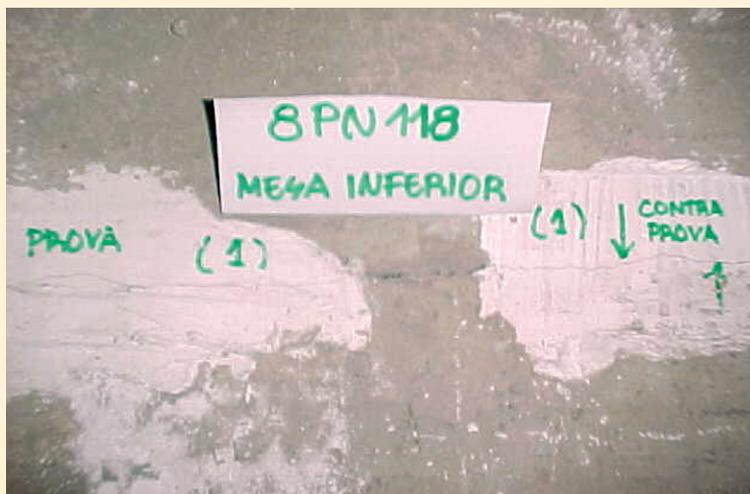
SELOS DE GESSO APLICADOS NA MESA INFERIOR DE ADUELA, EXIBINDO FISSURAS NA JUNTA COLADA (FONTE: INSPESIS ENGENHARIA – 2004)
